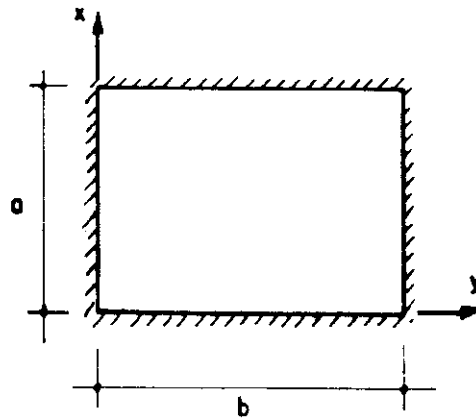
LAJE RETANGULAR SIMPLEMENTE APOIADA
